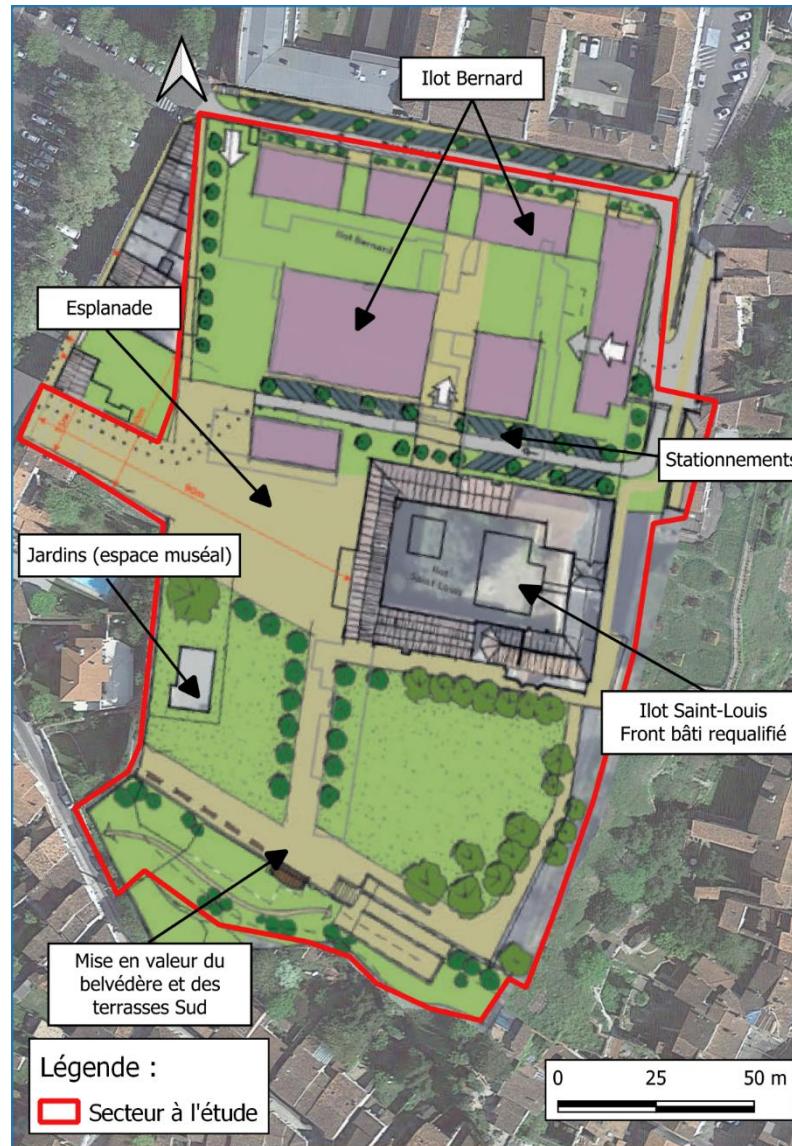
Carte de localisation du site d'étude – Fond de plan ortho photo
